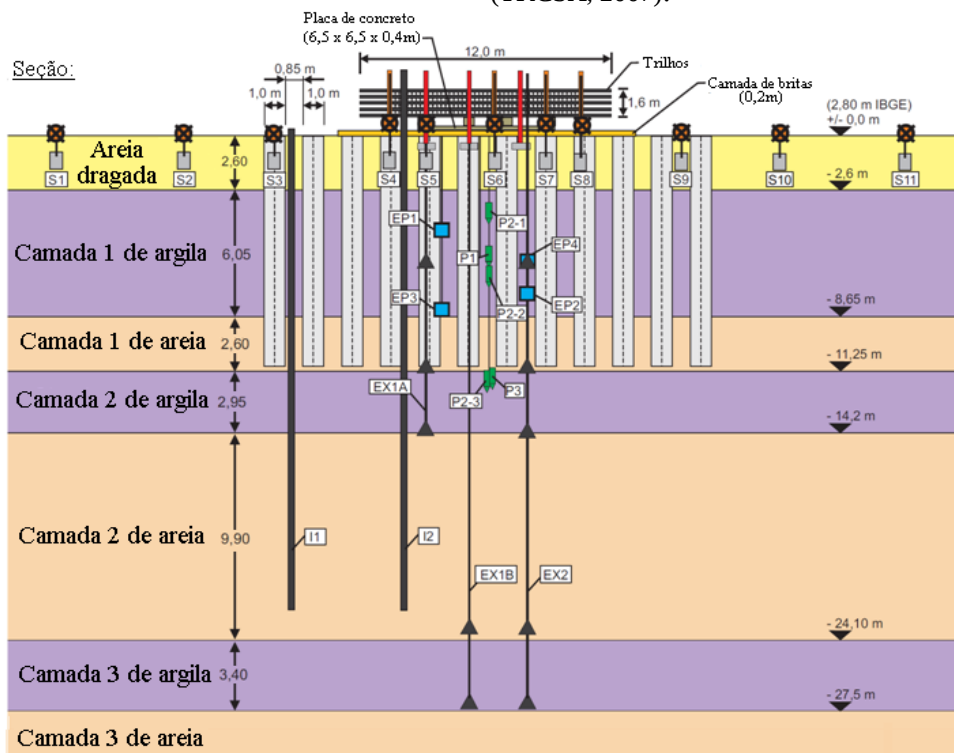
Perfil geotécnico, espaçamento e diâmetro das colunas, e instrumentação instalada. (TKCSA, 2007).
